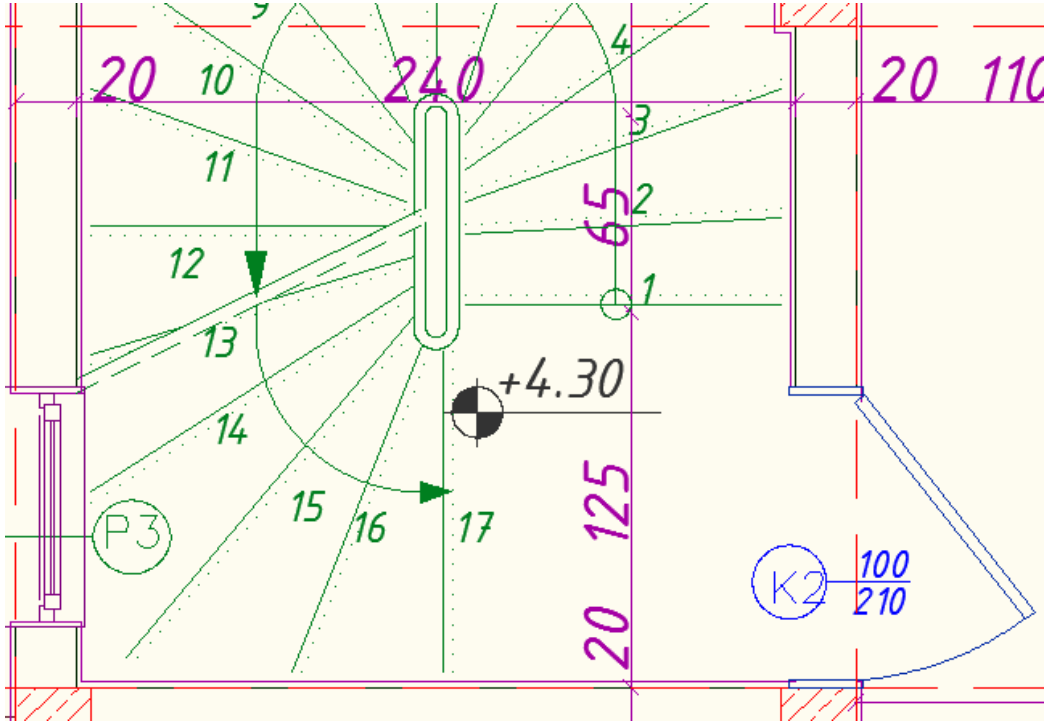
Normal kat planı arka cephe tek daireye ait dış ölçülendirmesi
